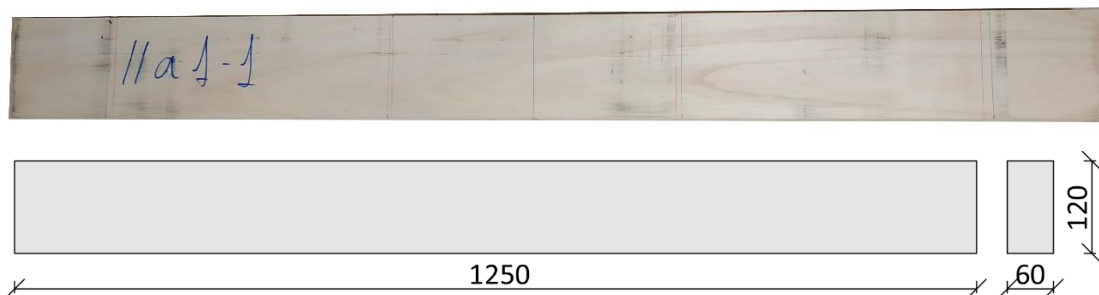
Ejemplo de probeta y dimensiones de una probeta para ensayo a flexión.
